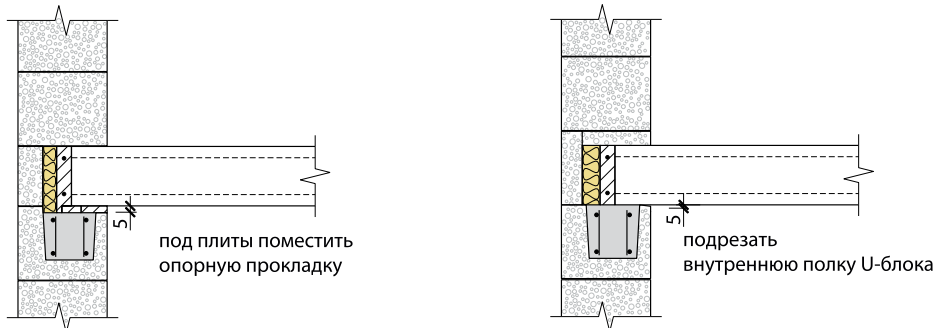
Варианты перекрытий по стенам из блоков ЛСР
